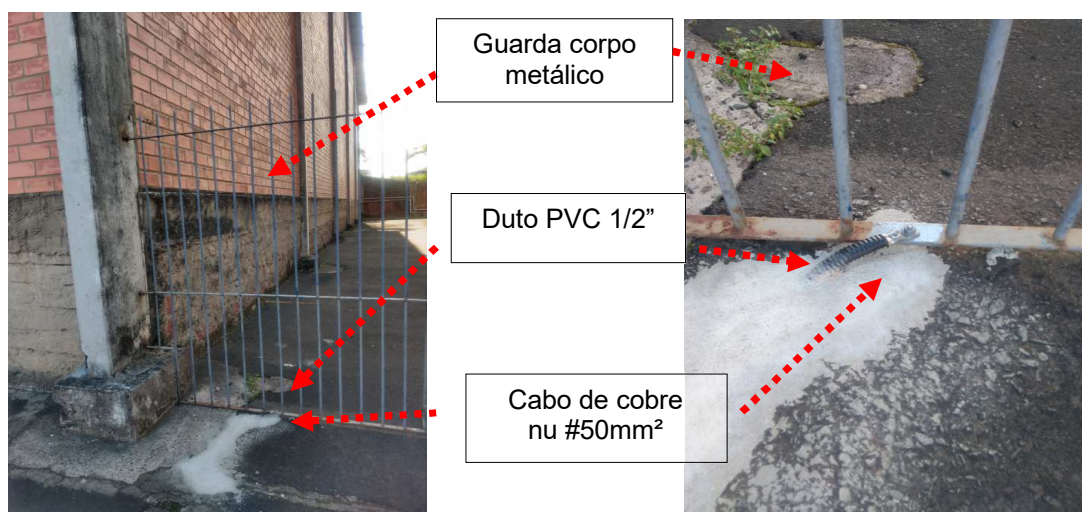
e 27: Equalização / Implantação de trecho em perfil e cabo de cobre nu.
